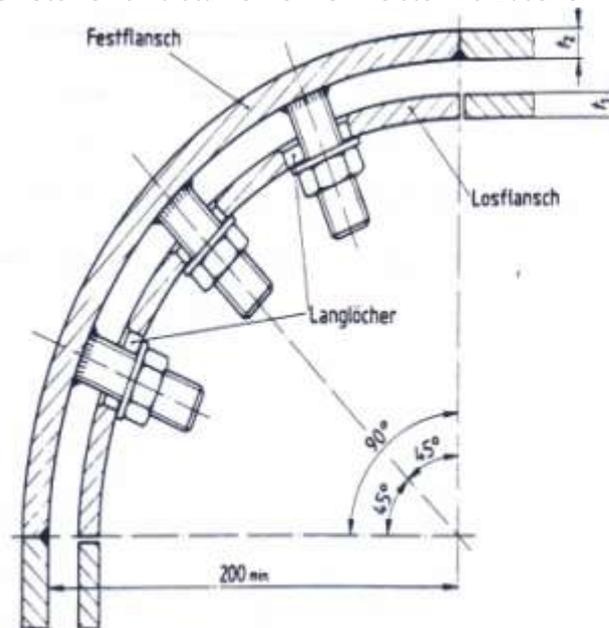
Los- und Festflanschkonstruktion bei Richtungsänderung der Abdichtungsebene, Längsschnitt
